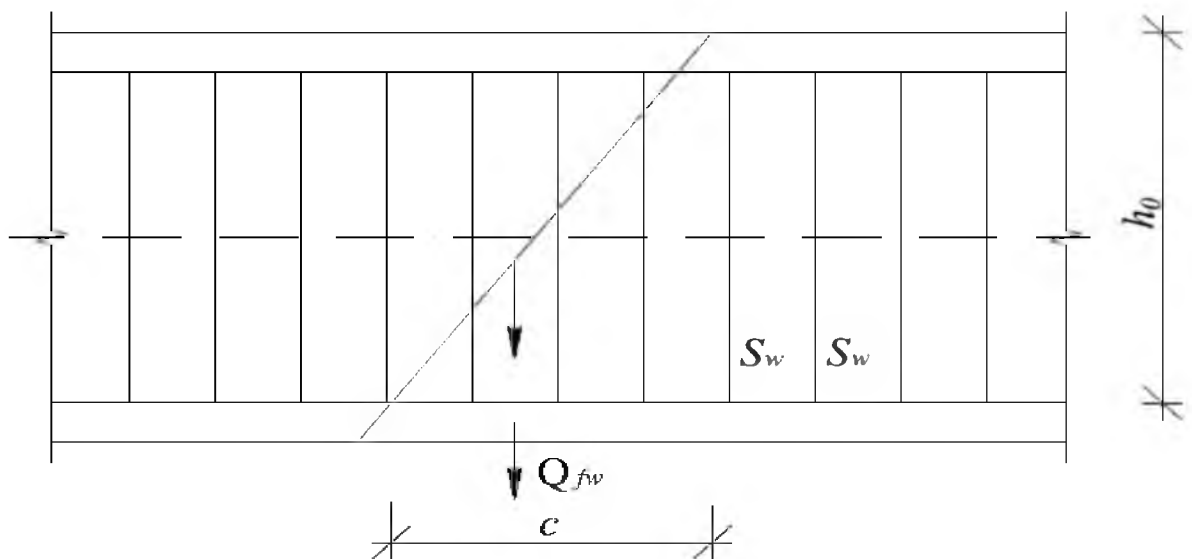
Схема усилий при расчете конструкций по наклонному сечению на действие поперечных сил.
